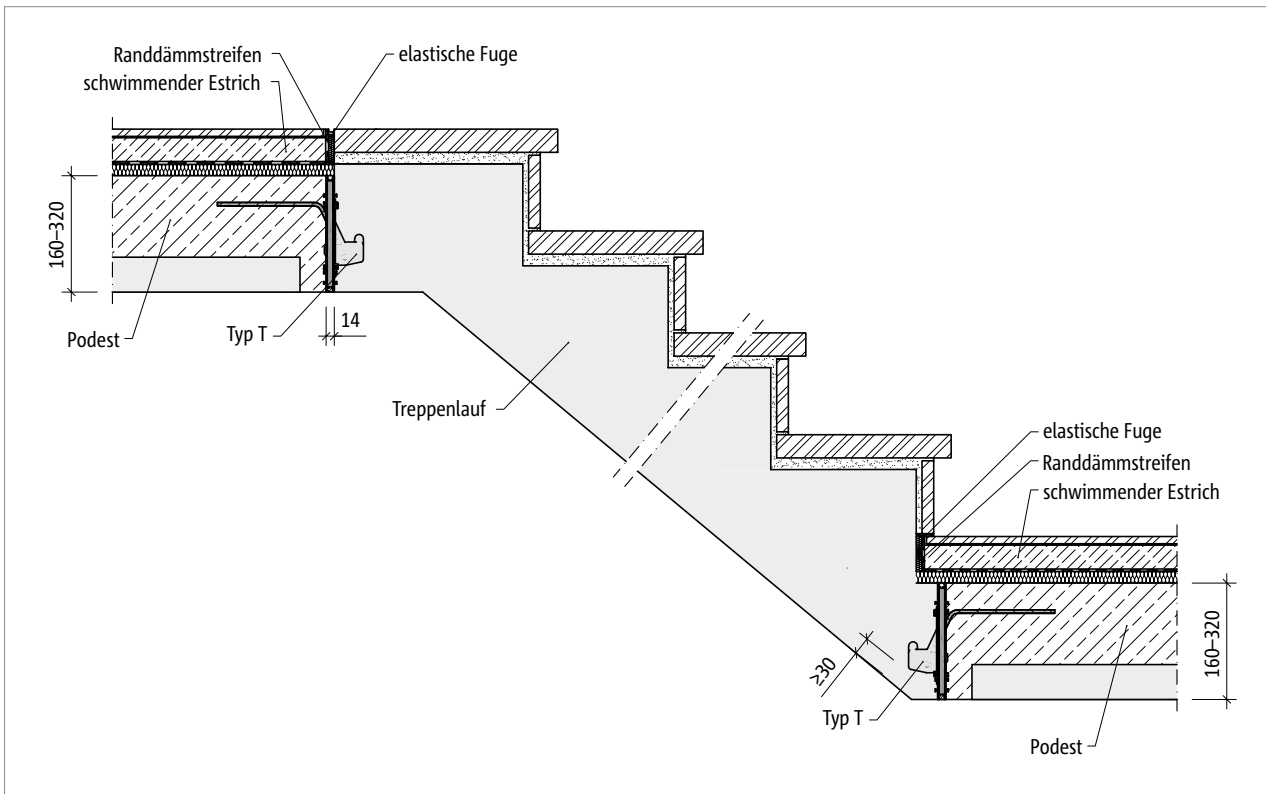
Schöck Tronsole® Typ T: Einbauschnitt Elementtreppe mit Halbfertigteilpodest
